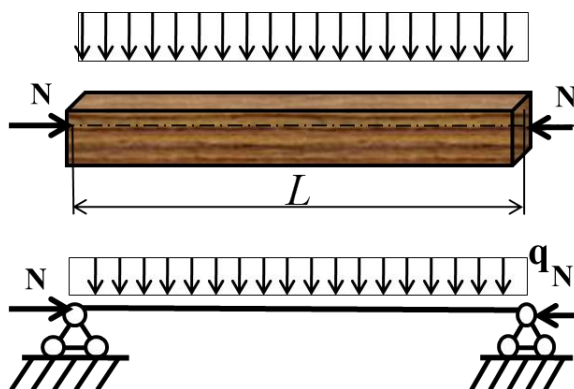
Схема стержня работающего на сжатие с изгибом
